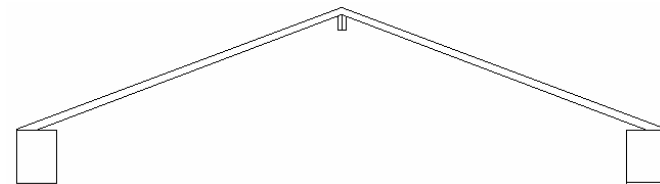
Cubierta inestable con viga de soporte. Fuente: Autores de proyecto.
